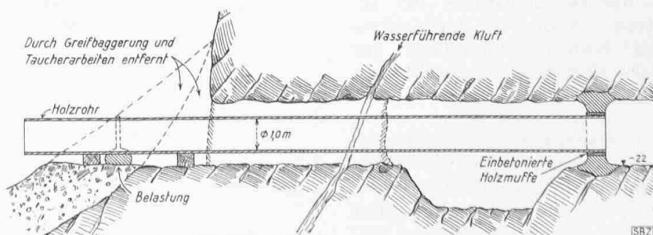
Anstichstelle mit eingeschobenem Fassungs-Holzrohr
